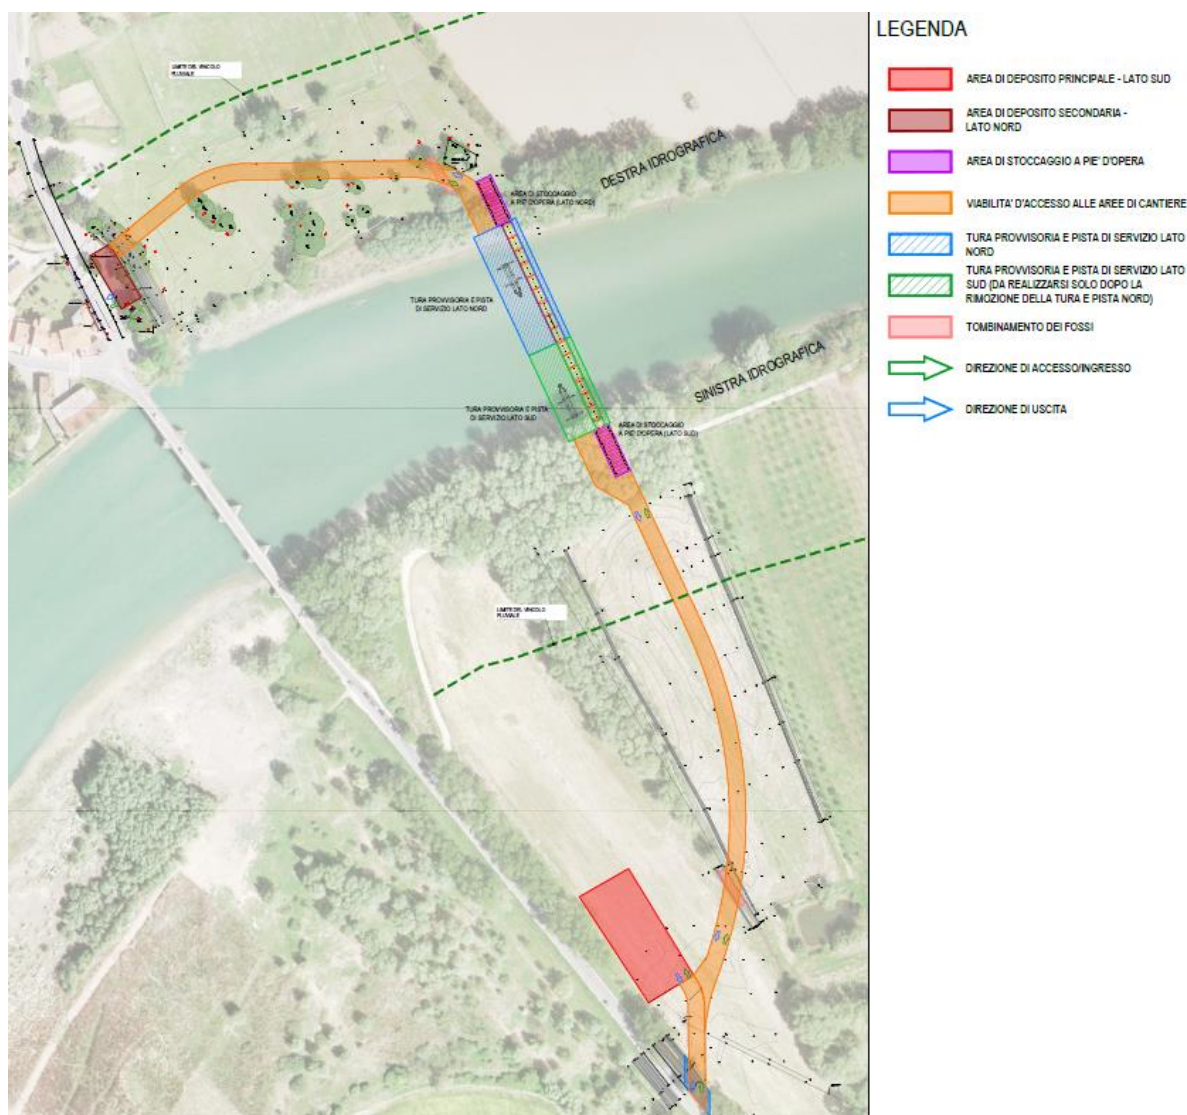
individuazione delle aree di cantiere (si neda Tav. ME20)
